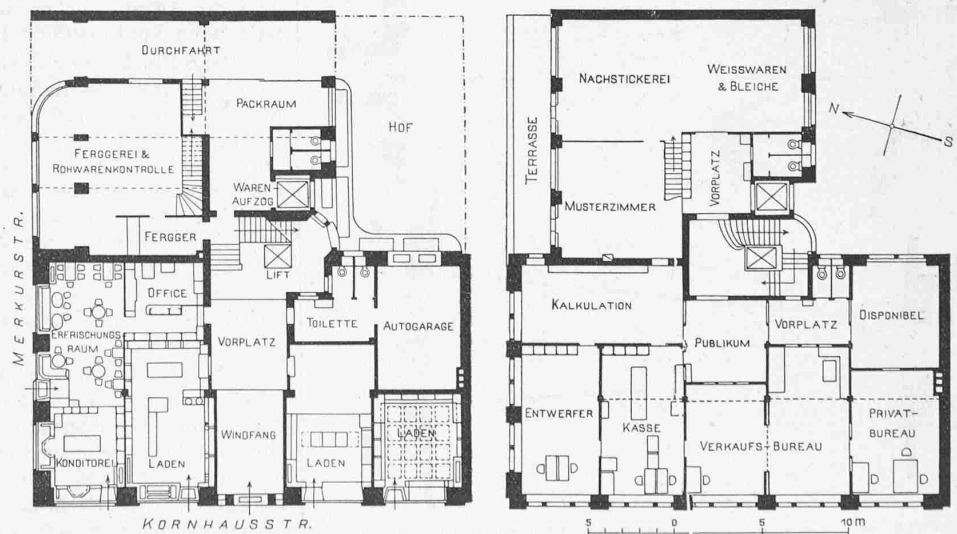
Grundriss vom Erdgeschoss. — 1:400 — Abb. 2. Grundriss vom ersten Obergeschoss.
